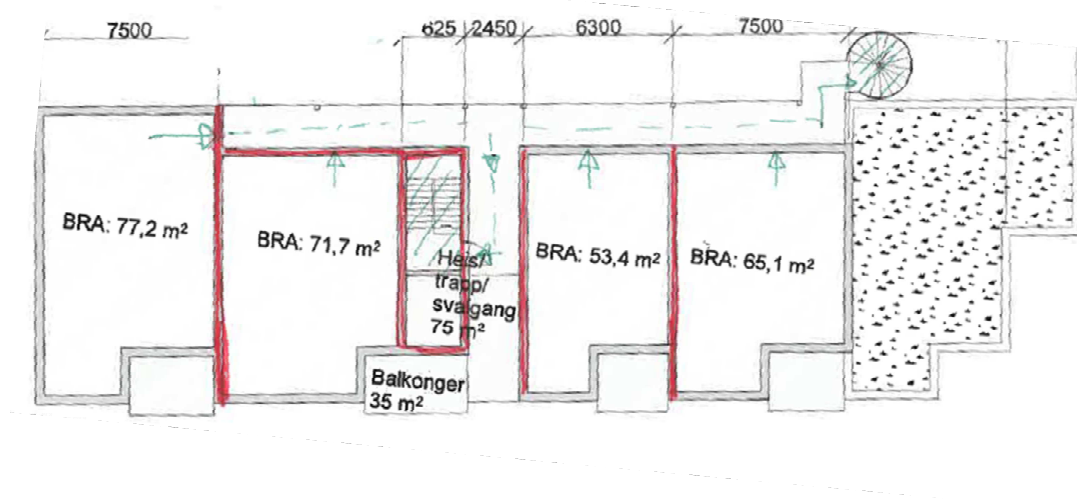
Plan 2. Rød strek angir krav til branncellebegrensende konstruksjon
